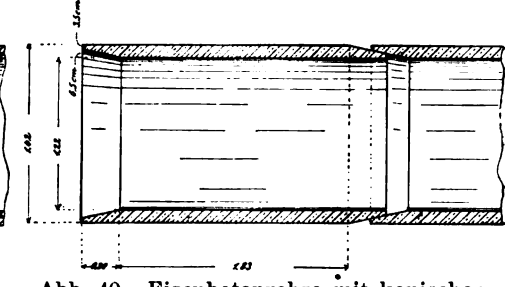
Eisenbetonrohre mit konischer Stoßverbindung. 1:40.
